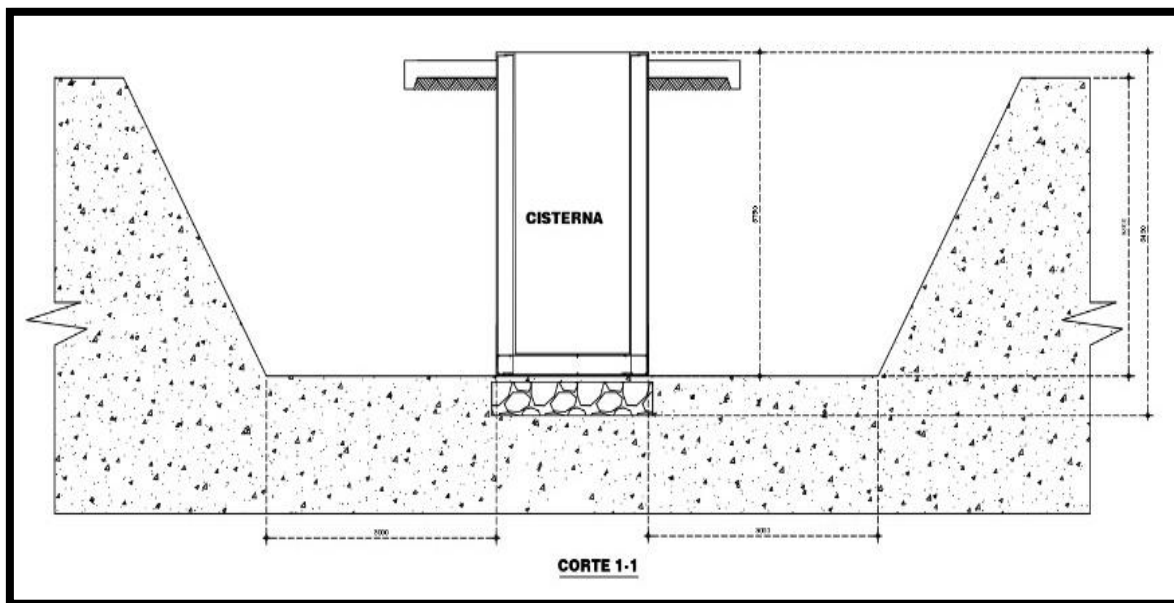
Plano de corte - cisterna sin elementos metálicos
